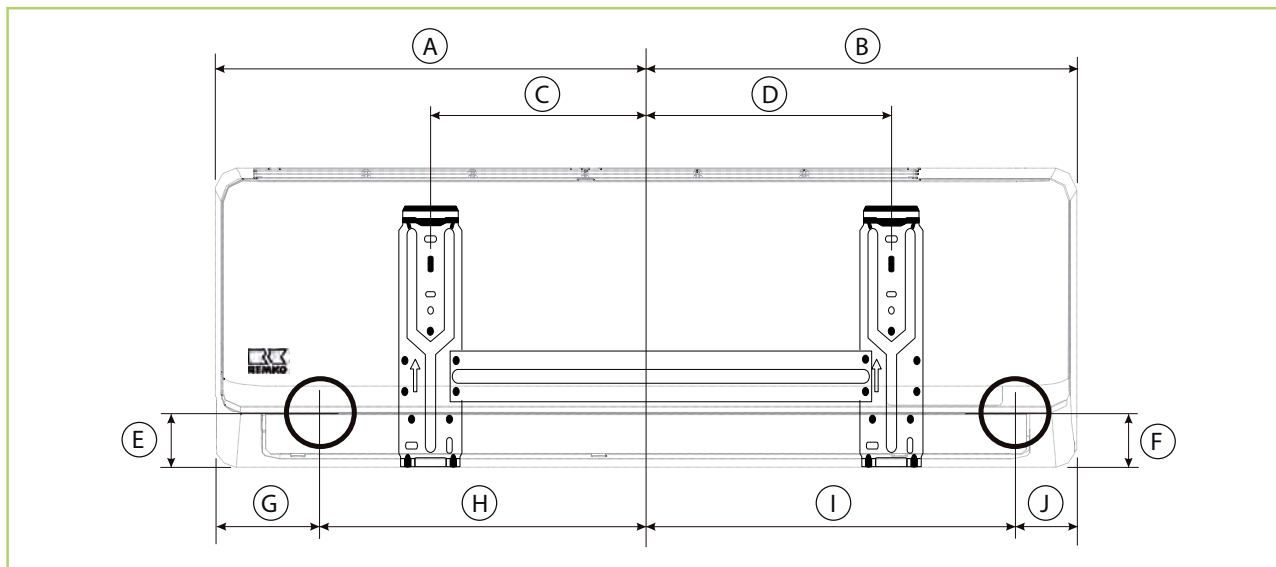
Montagepunkte der Wandhalterung BL 262-352 DC IT (Frontansicht, alle Maße in mm)
